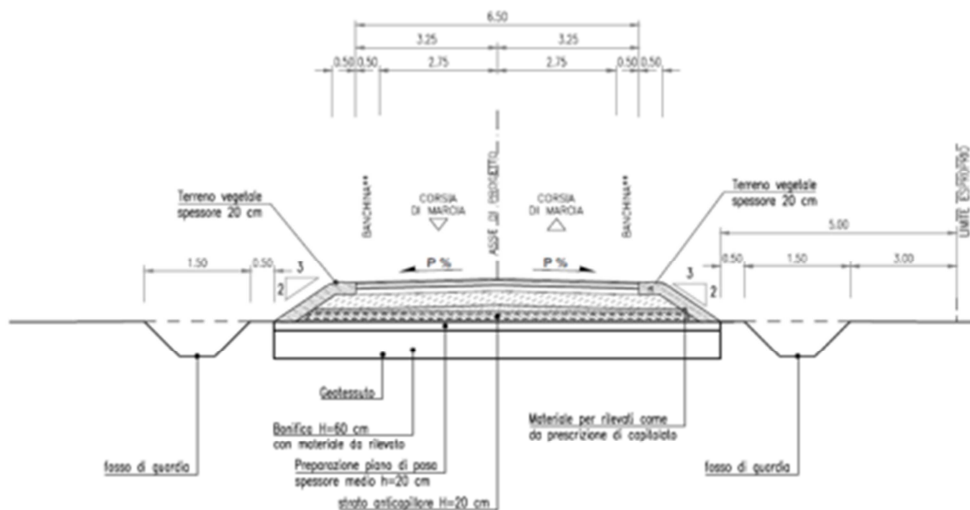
Sezione Tipo Strada Locale a destinazione particolare Est in rettilineo
